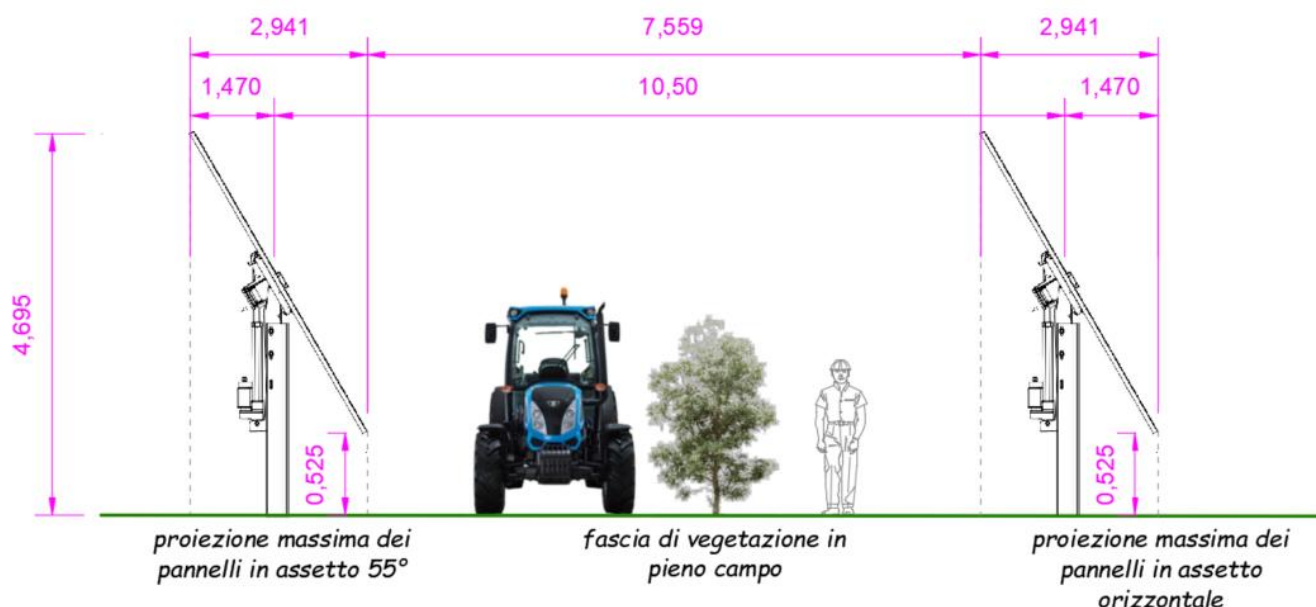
Sezione tipo con pannelli in assetto inclinato (55°)
